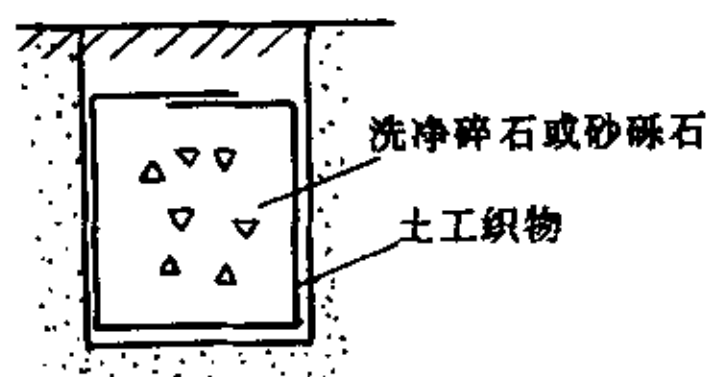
土工织物包裹碎石或砂砾石渗沟断面示意图
